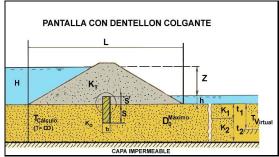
Presa con Dentellón Flotante (no llega a la capa impermeable)
